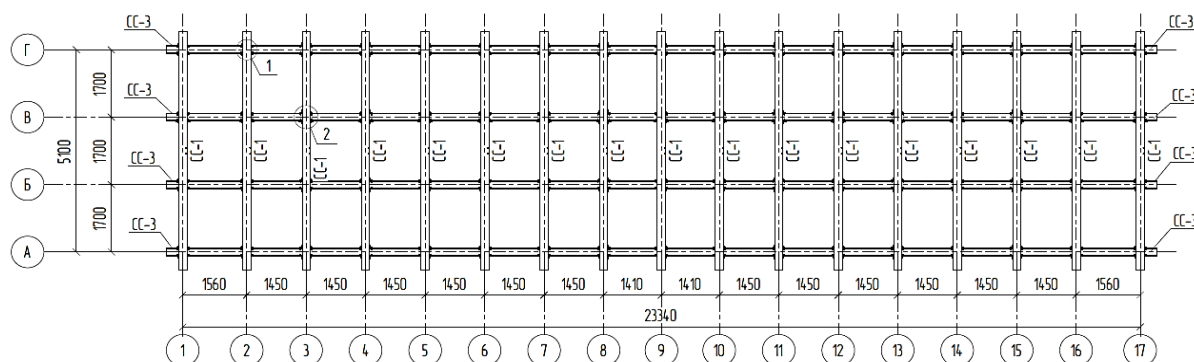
План стенда для испытания ферм пролетом до 24 м в горизонтальном положении:
